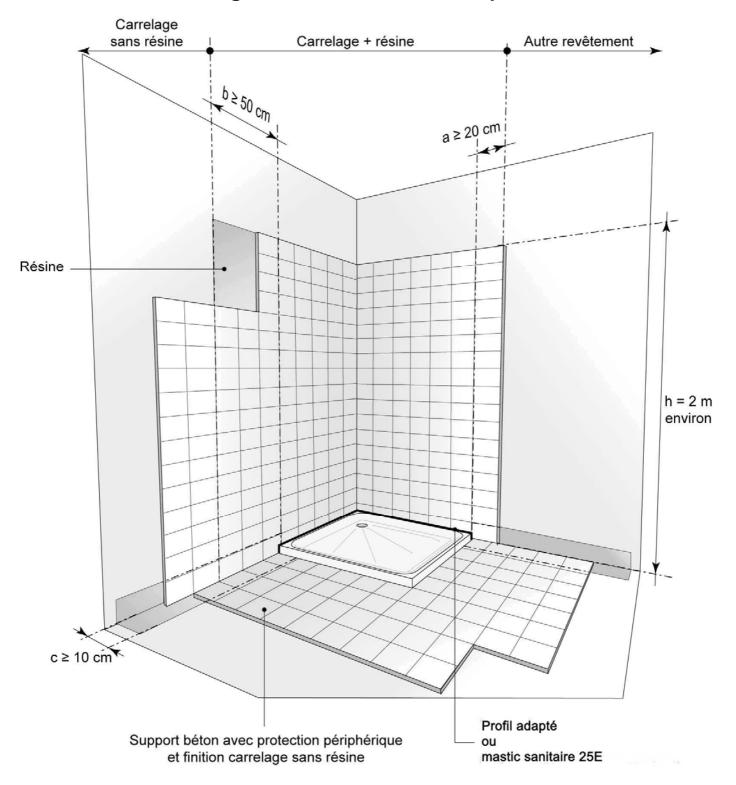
Rénovation sur plaques de parement en plâtre non hydrofugées existantes en local EB+ privatif, avec douche ou baignoire sans pare-douche. Nota : les utilisateurs considèrent généralement qu'une paroi carrelée n'est pas sensible aux projections d'eau. C'est pourquoi la zone protégée déborde plus largement dans le cas où toute la paroi est carrelée.
